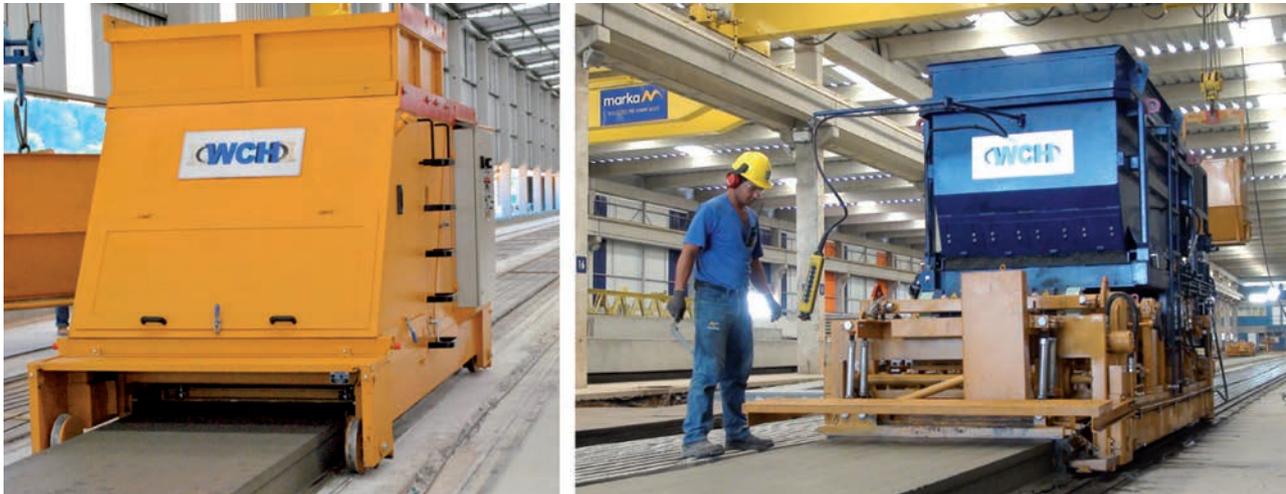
Máquina extrusora (foto à esquerda); máquina moldadora com formas deslizantes (foto à direita) [Cortesia WCH Weiler C. Hotzberger, 2014]
